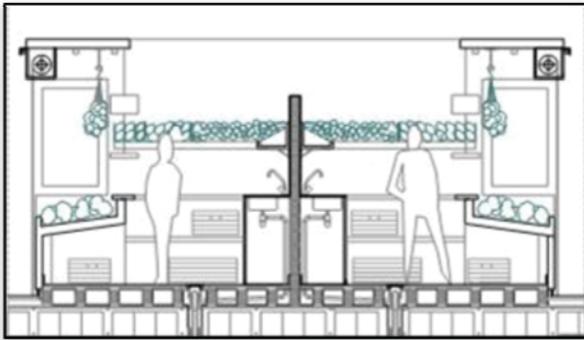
Sistemas constructivos utilizados en el proyecto.
